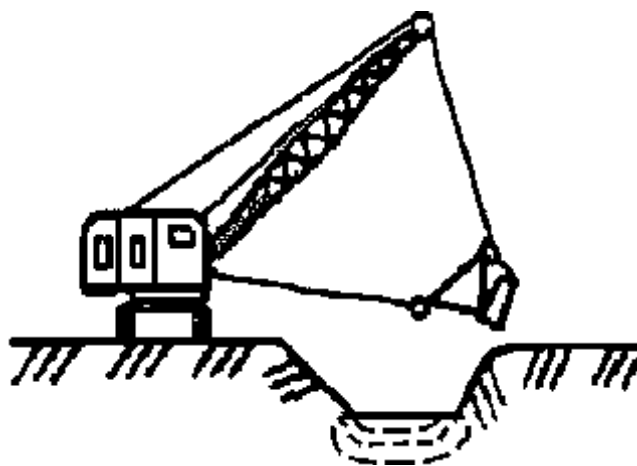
Расструктурирование грунта при ударе по дну котлована тяжелых механизмов
